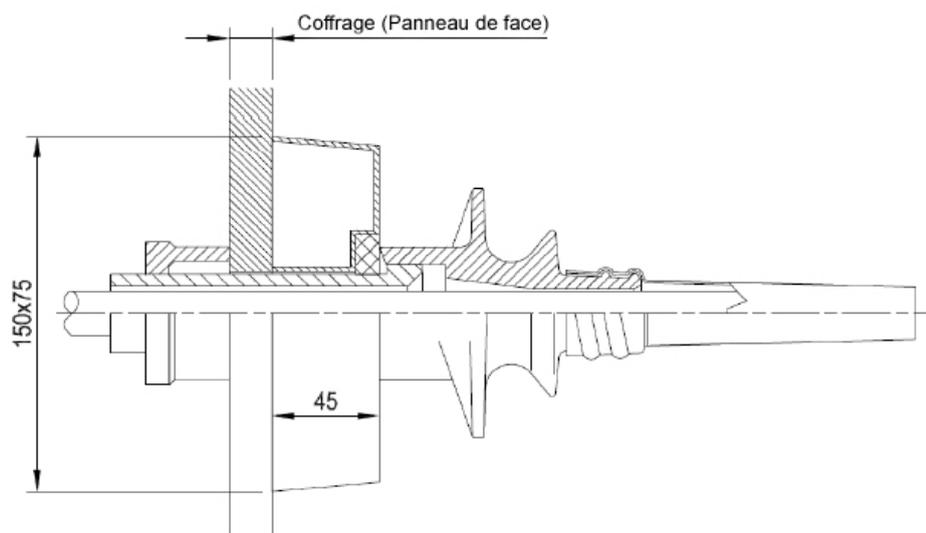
Ancrages type S 6-1 - Dimensions du dispositif d'installation
